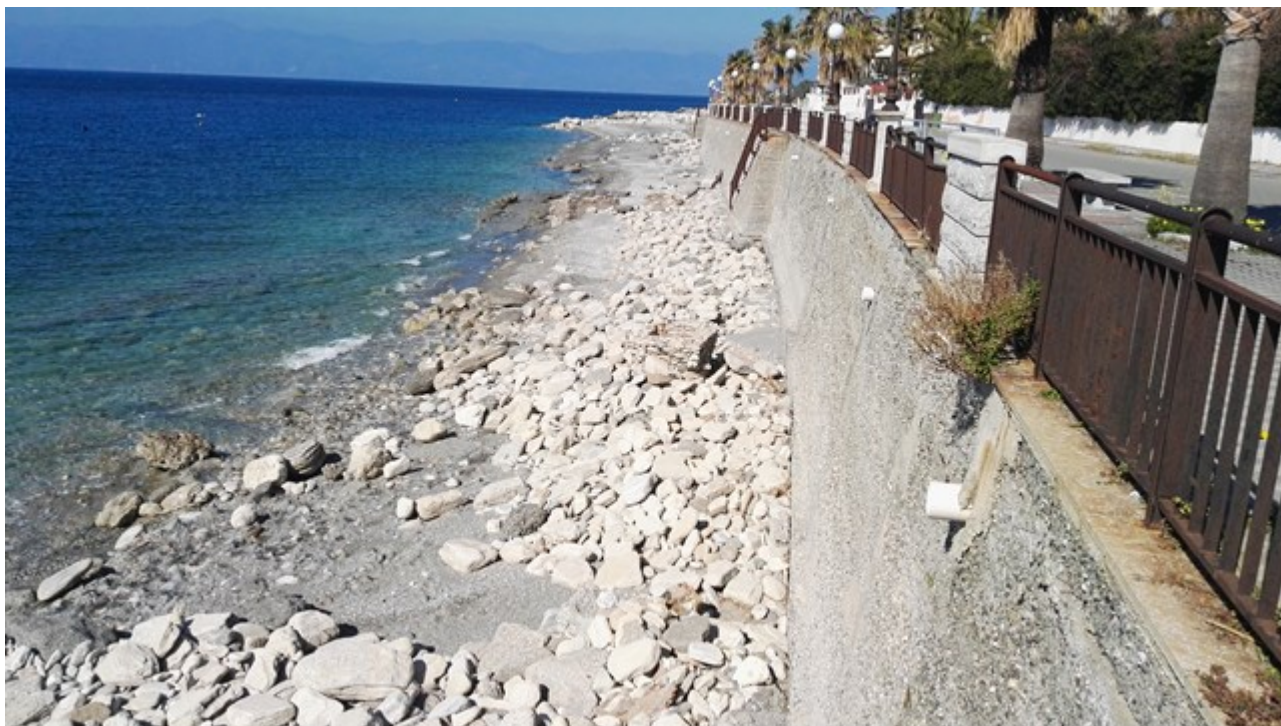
Inizio lato Sud Lungomare Cicerone zona A Lazzaro
